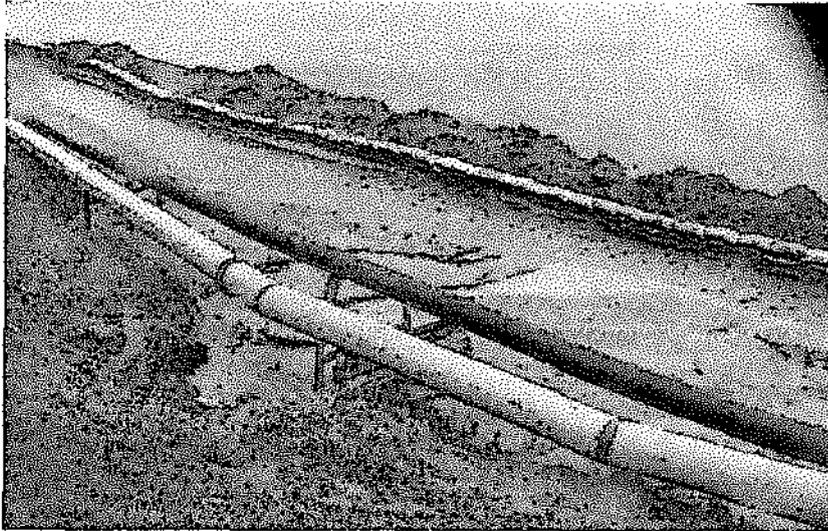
Canal de conducción de lodos de planta de neutralización de aguas ácidas sobre terreno natural y encimado con sacos metaleros llenos de arena, en antigua vía de acceso, al costado se observan las líneas de conducción de relaves hacia la presa Ocroyoc, UEA Cerro de Pasco.
